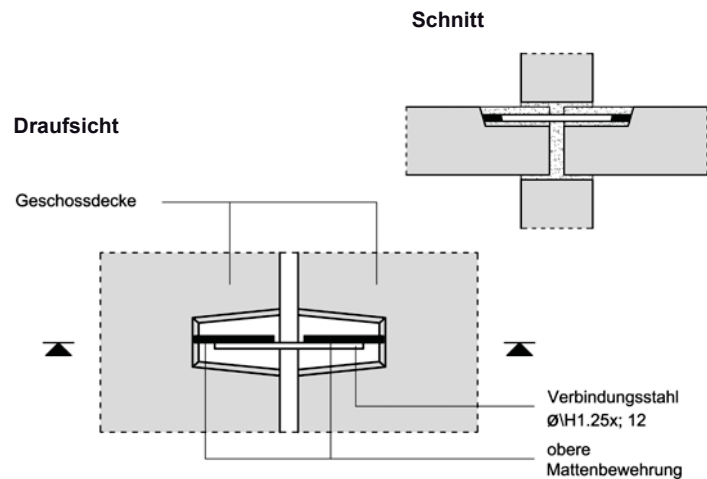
Verbindung Decke – Decke längs zur Spannrichtung⁴⁹
